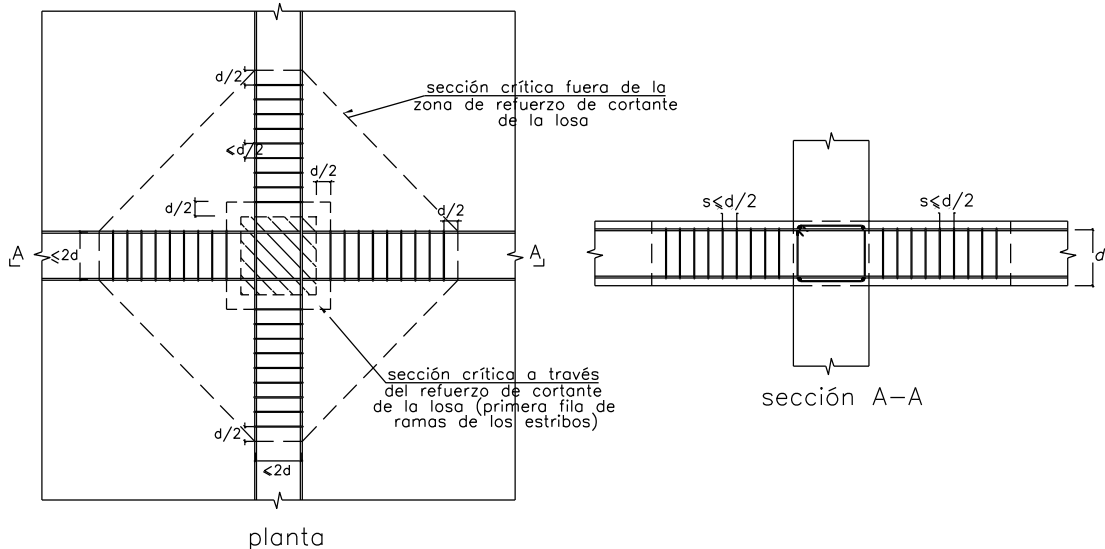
a Disposición de los estribos por cortante en columnas interiores.
